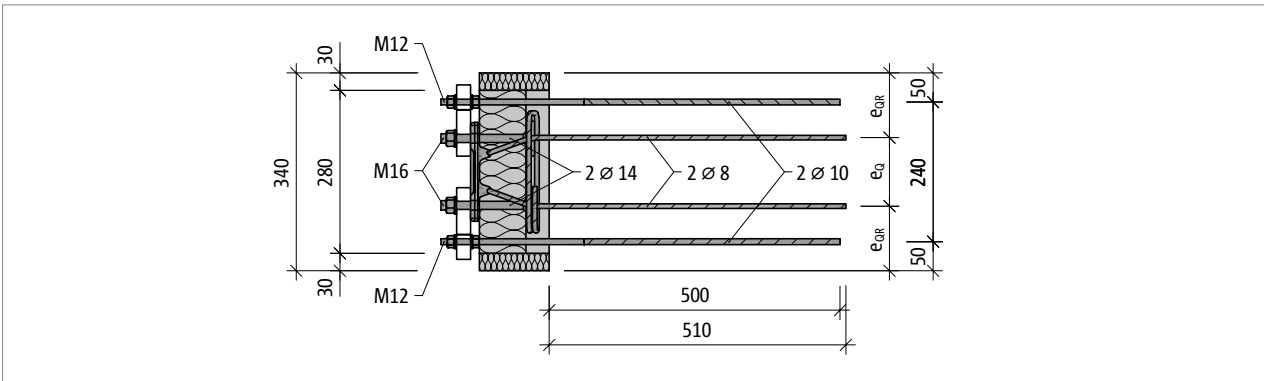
Schöck Isokorb® RT Typ SK-M1: Produktgrundriss
